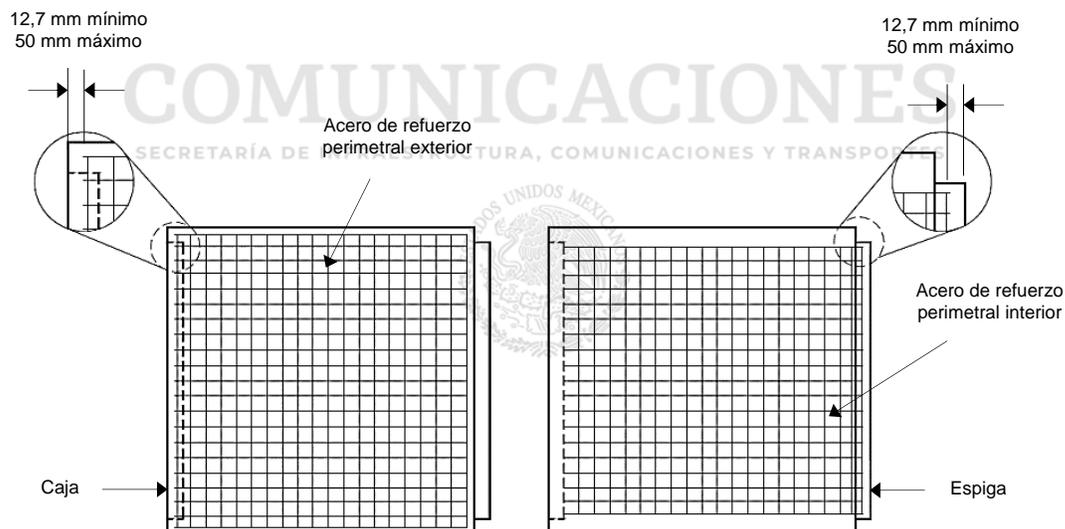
Vista lateral del acero de refuerzo en el extremo de la espiga y en el extremo en caja
